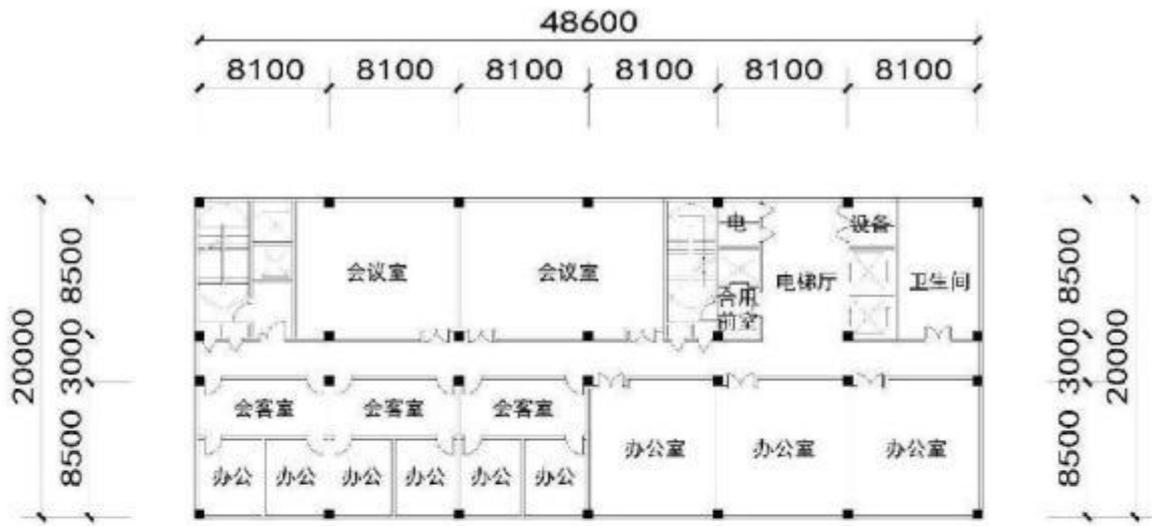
(4) 各层平面布置图 (南院区住院楼)
